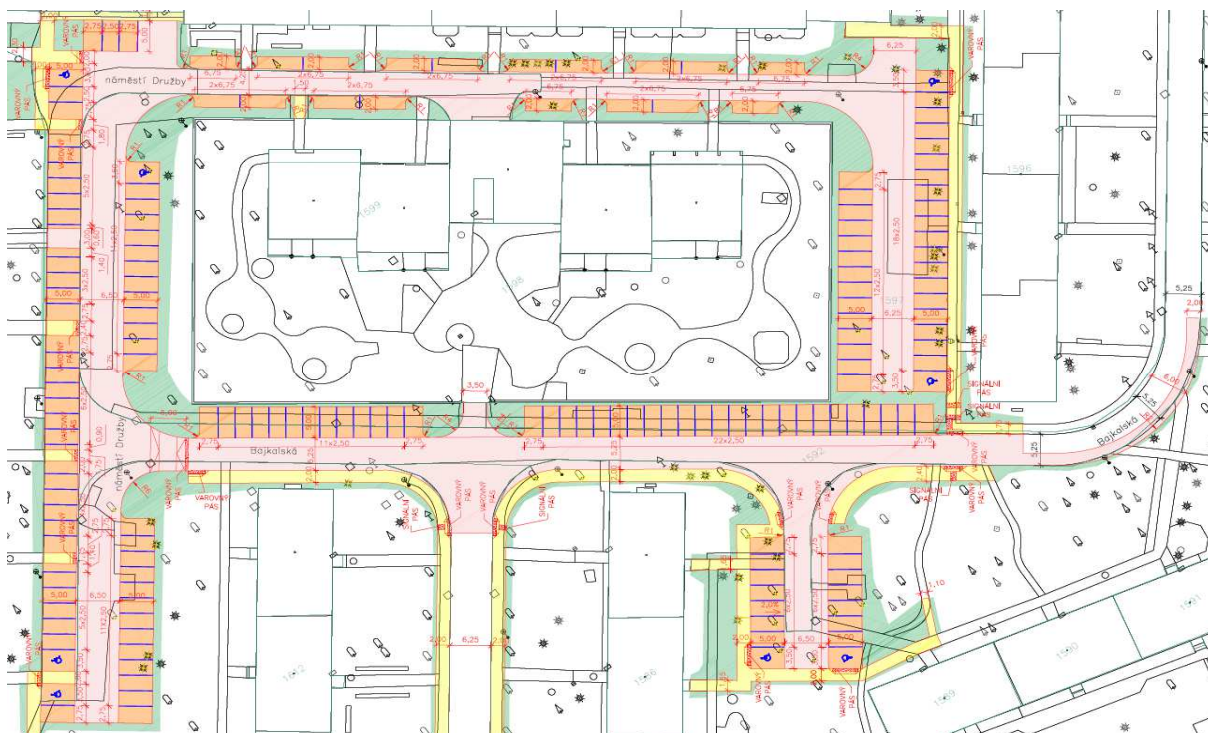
Varianta 1 - Parkovací dům - část D
